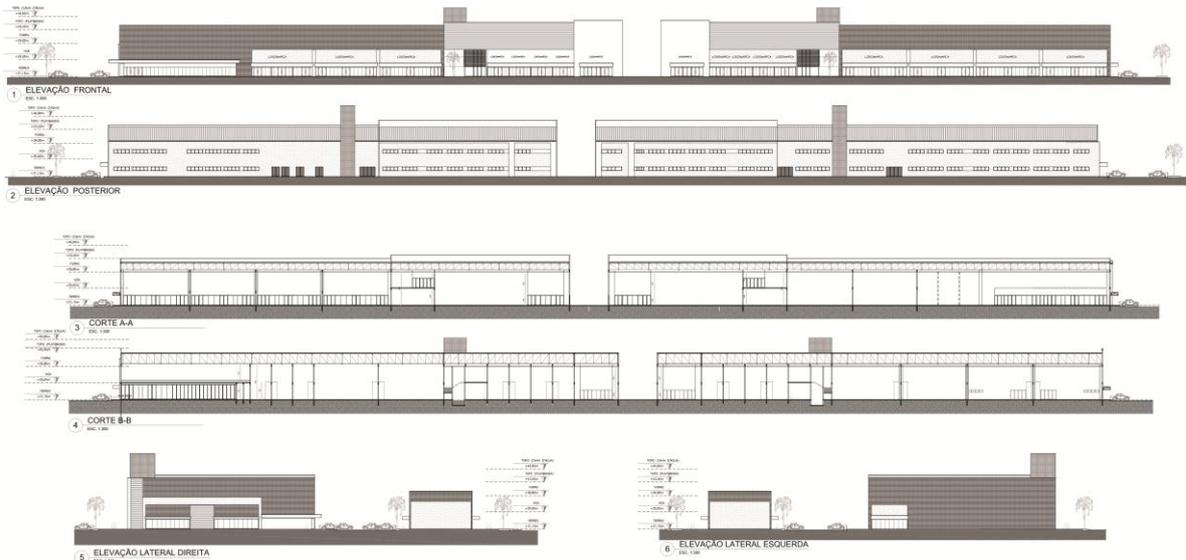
Fachadas apresentadas pelo o arquiteto.
